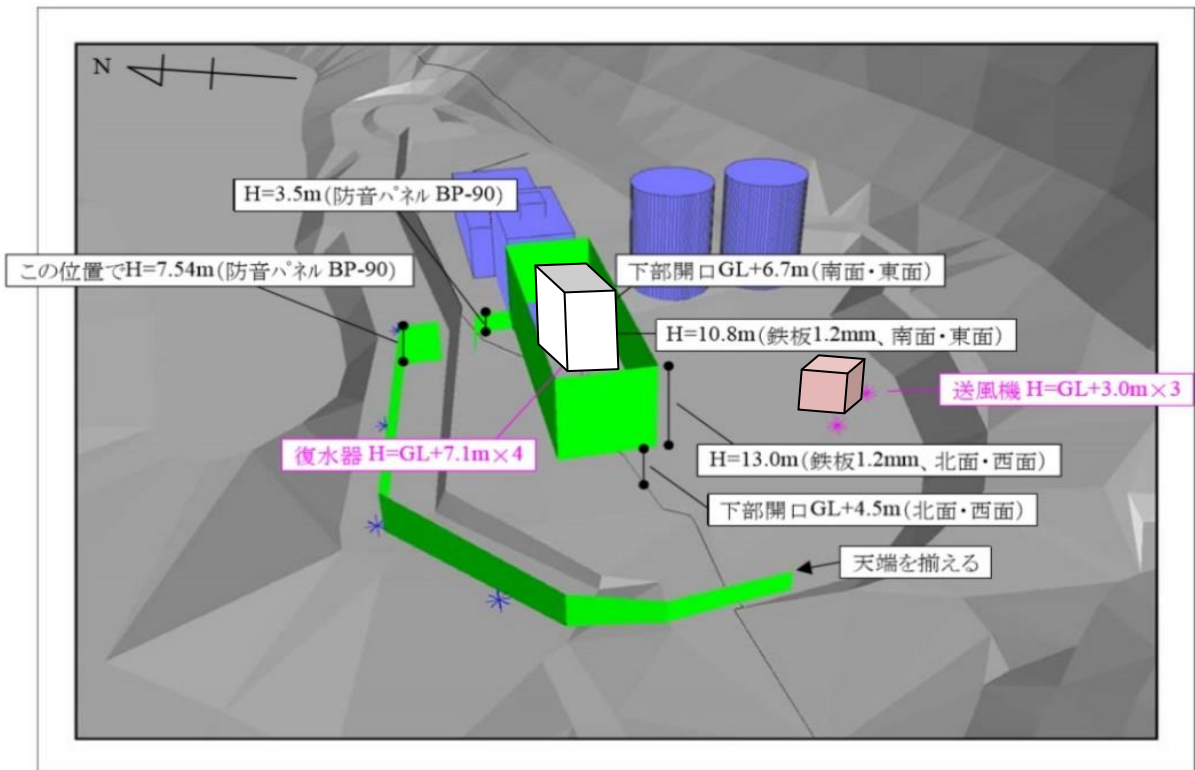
セットバック後の防音壁の位置・高さ立面図
